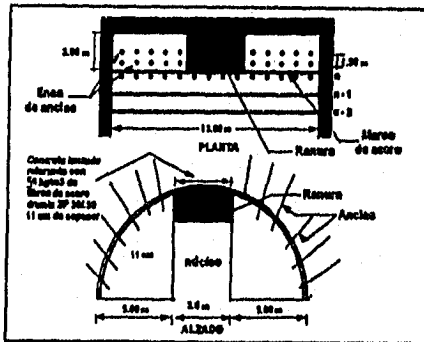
Excavación de la porción superior del tercio central y colocación del concreto lanzado en la clave.
